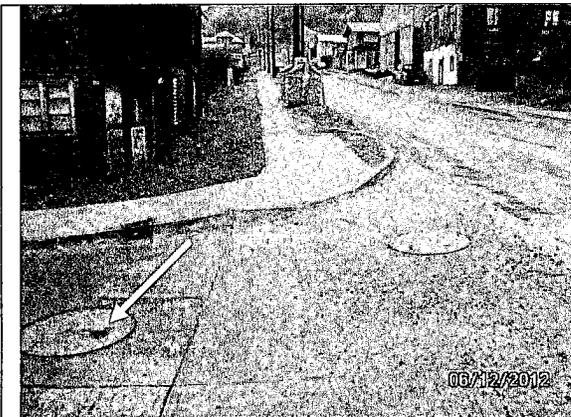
TAPA CÁMARA CON HORMIGÓN DEFICIENTE
